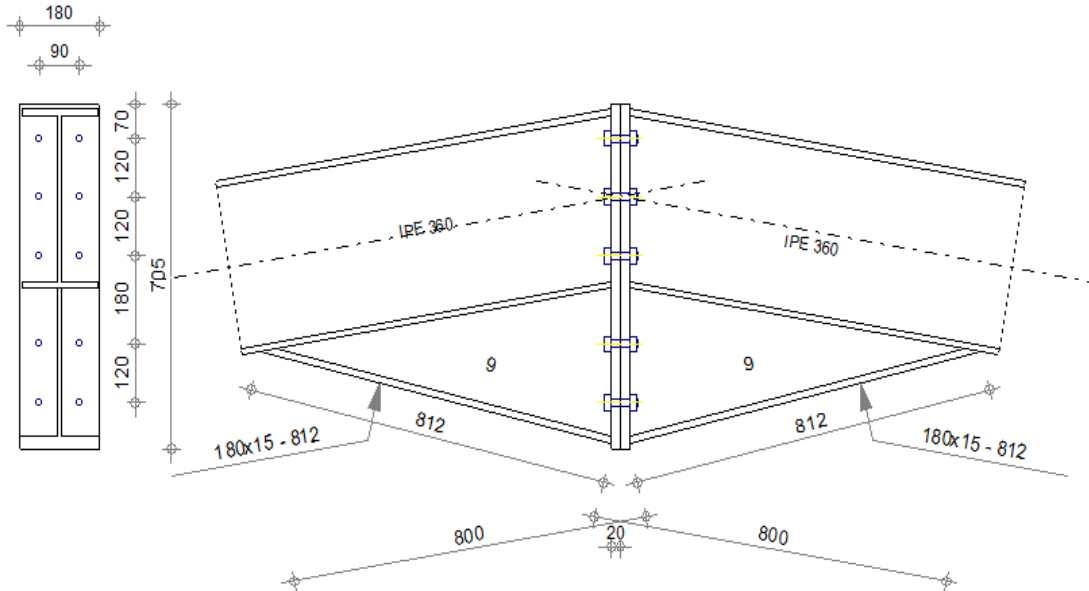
Vu en plan de l'assemblage traverse-traverse.
